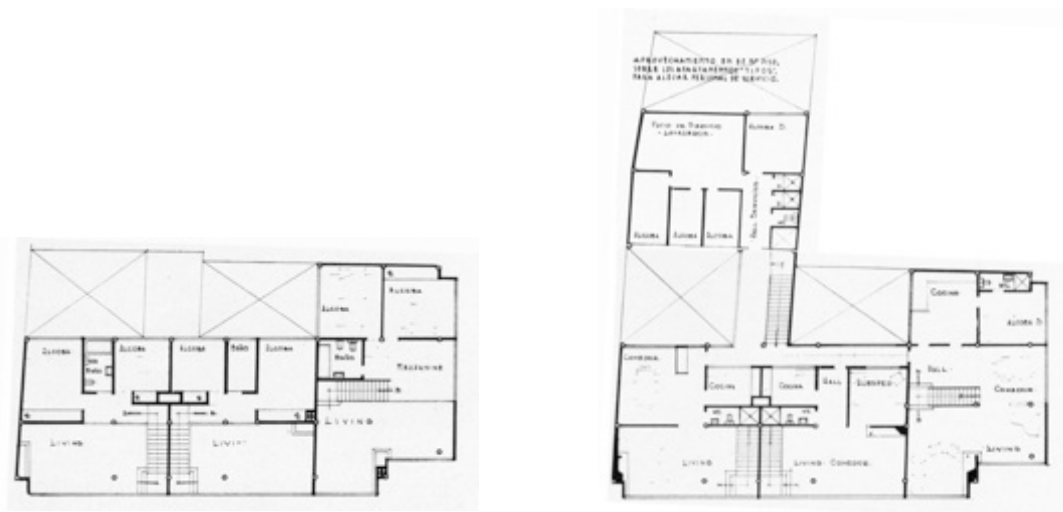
Plantas del Quinto y Sexto Piso - Apartamentos dúplex y zona de lavado y alcobas de servicio en el quinto piso.
